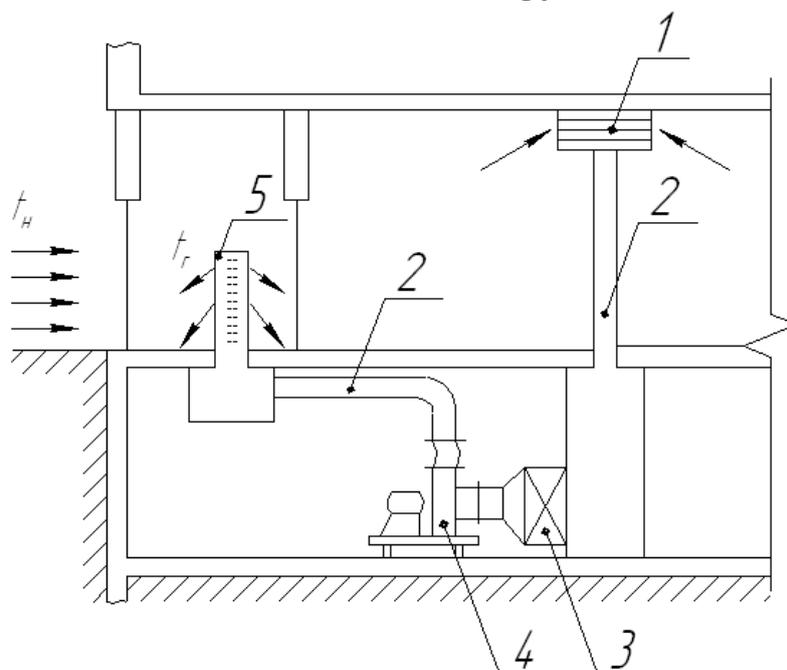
Воздушно-тепловая завеса: 1 – забор воздуха; 2 – воздухопровод; 3 – калорифер; 4 – вентилятор; 5 – раздача воздуха
